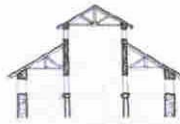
Viguera inclinada con armaduras de madera y alfarjes
